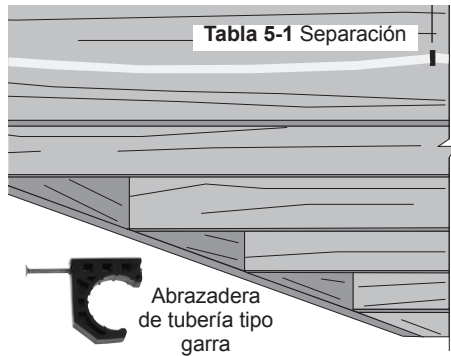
Soportes de tubería tipo garra para tramos horizontales
